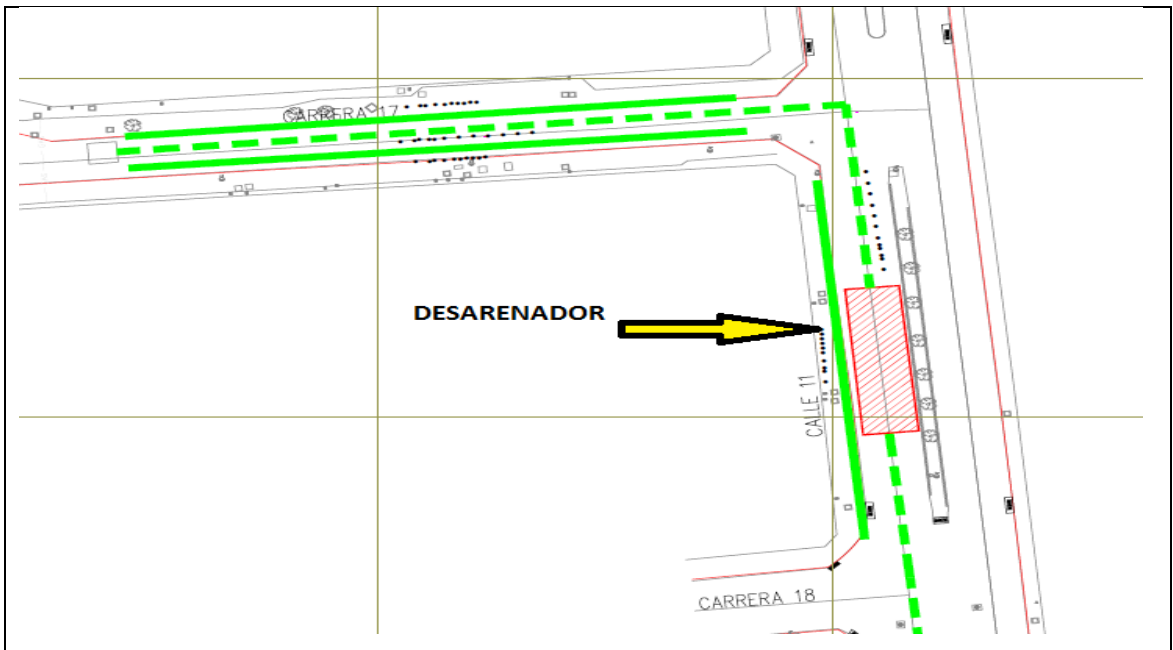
Instalación tubería de 12” entre cámaras tipo B CN24-CN22 en la calle 11 entre carrera 19 y 18
